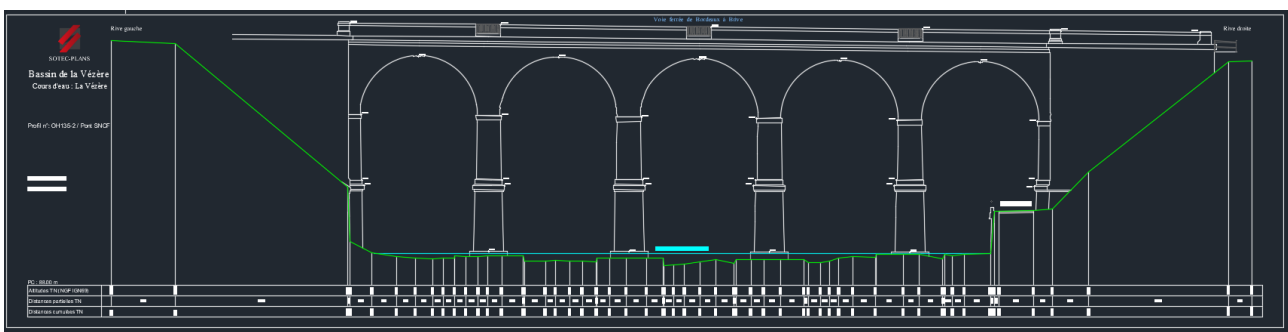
Exemple de coupe d'un ouvrage sur la Vézère (novembre 2023 - source Setec Plans)
